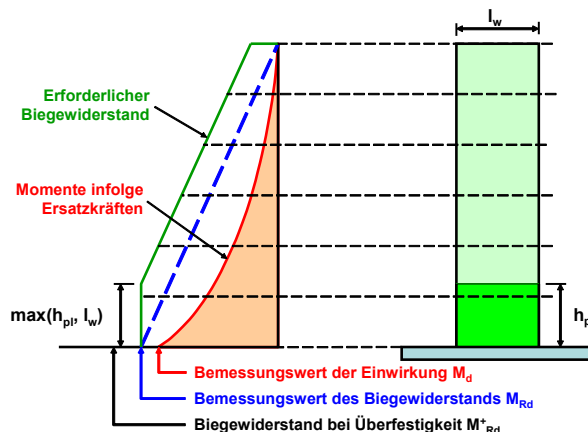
Momentenlinie zur Bemessung von schlanken Stahlbetontragwänden.
